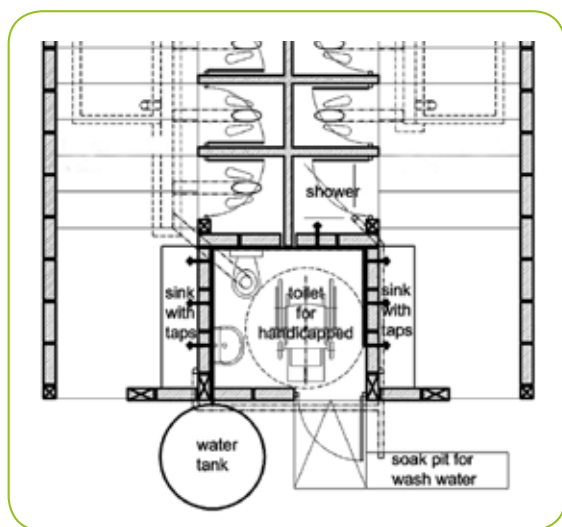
Plano de las instalaciones de un baño en Ruanda. (Fuente: UNICEF)
